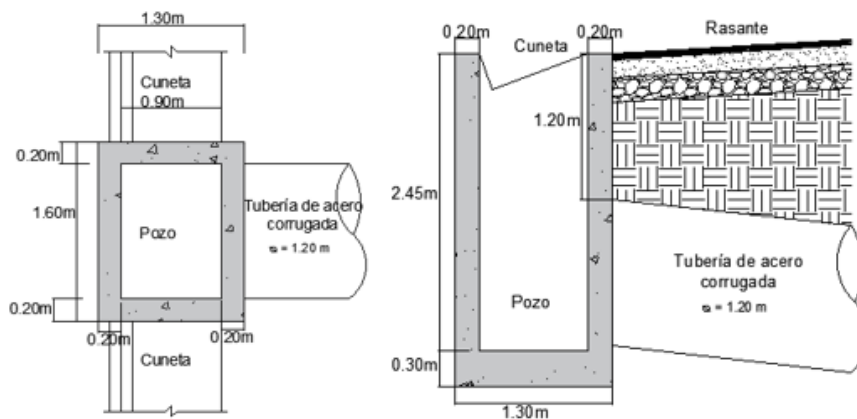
Cajón de entrada para alcantarilla para drenaje de calzada.
